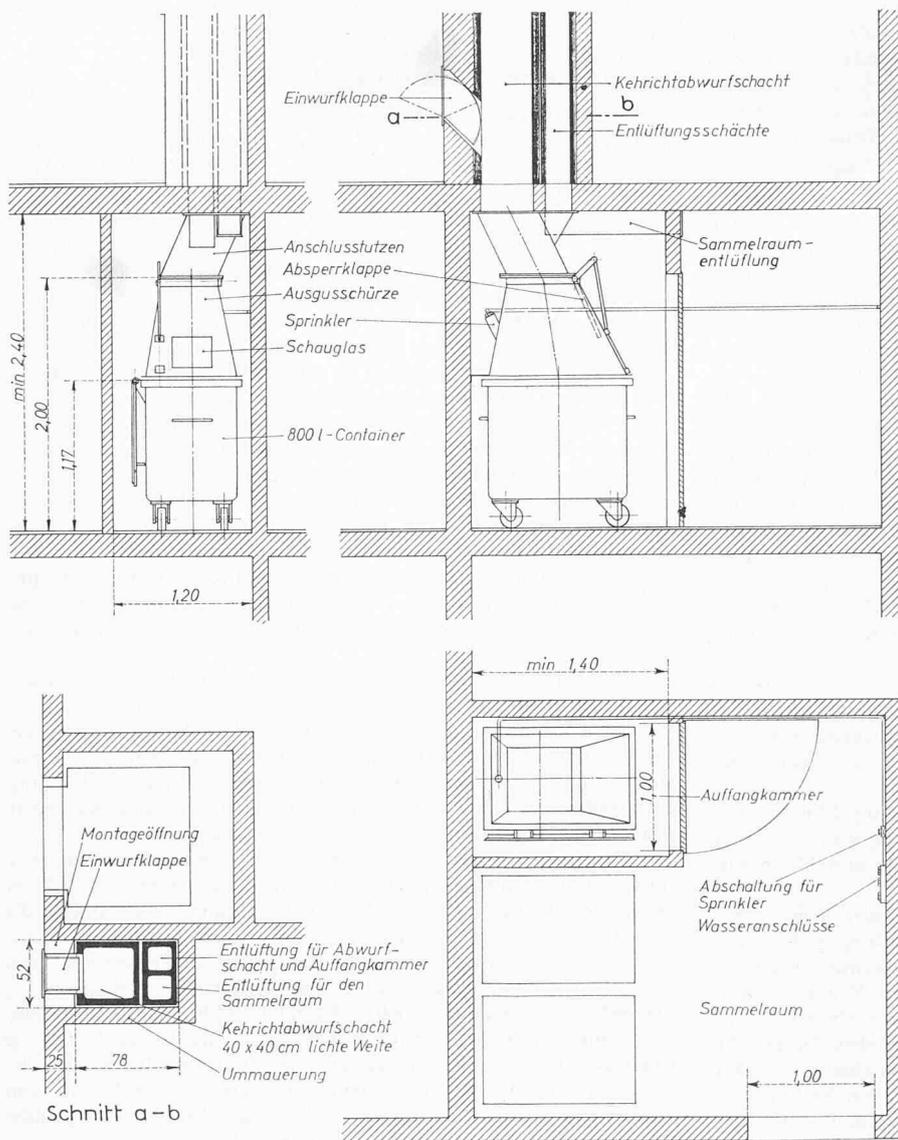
Auffangkammer und Sammelraum für Container 800 l. Grundriss und Schnitte 1:60
